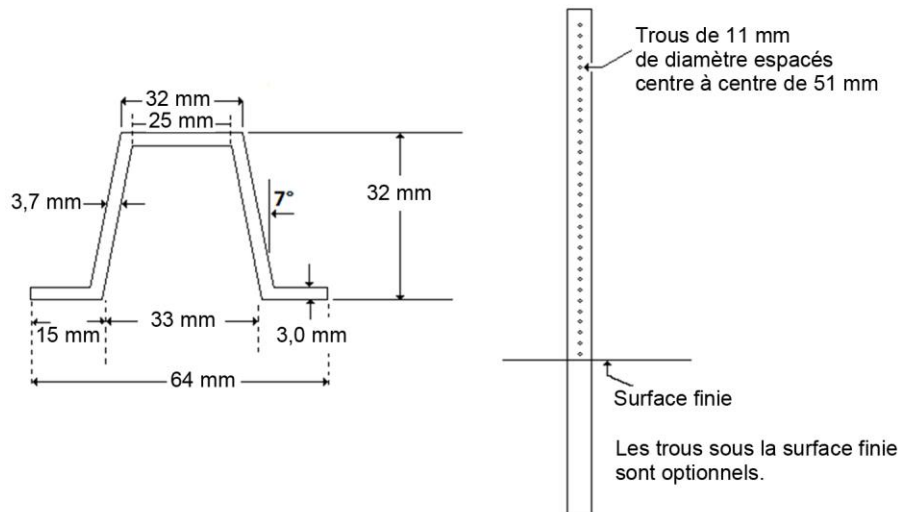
b) Détail du poteau d'acier plié à chaud
